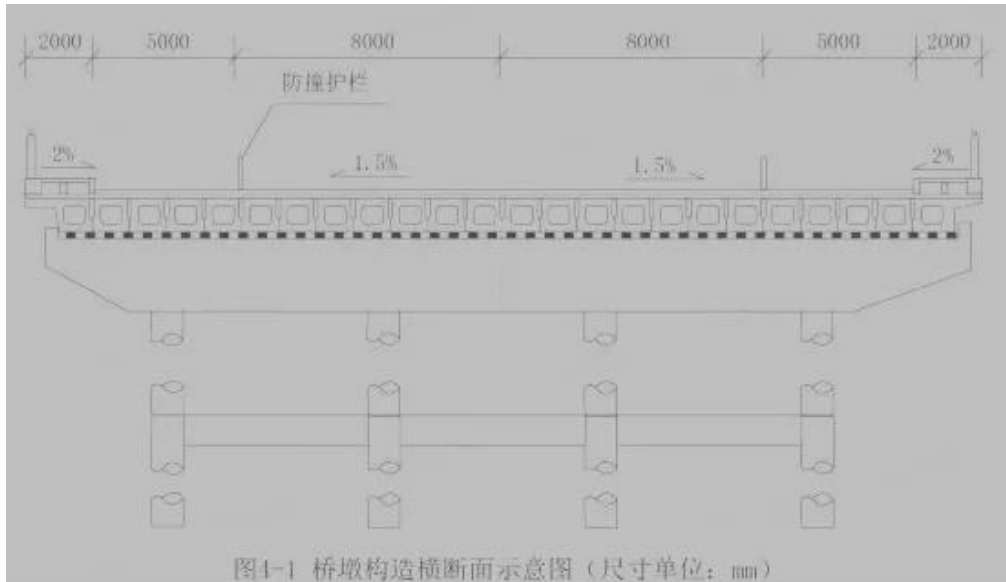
桥墩构造横断面示意图（尺寸单位：mm）
